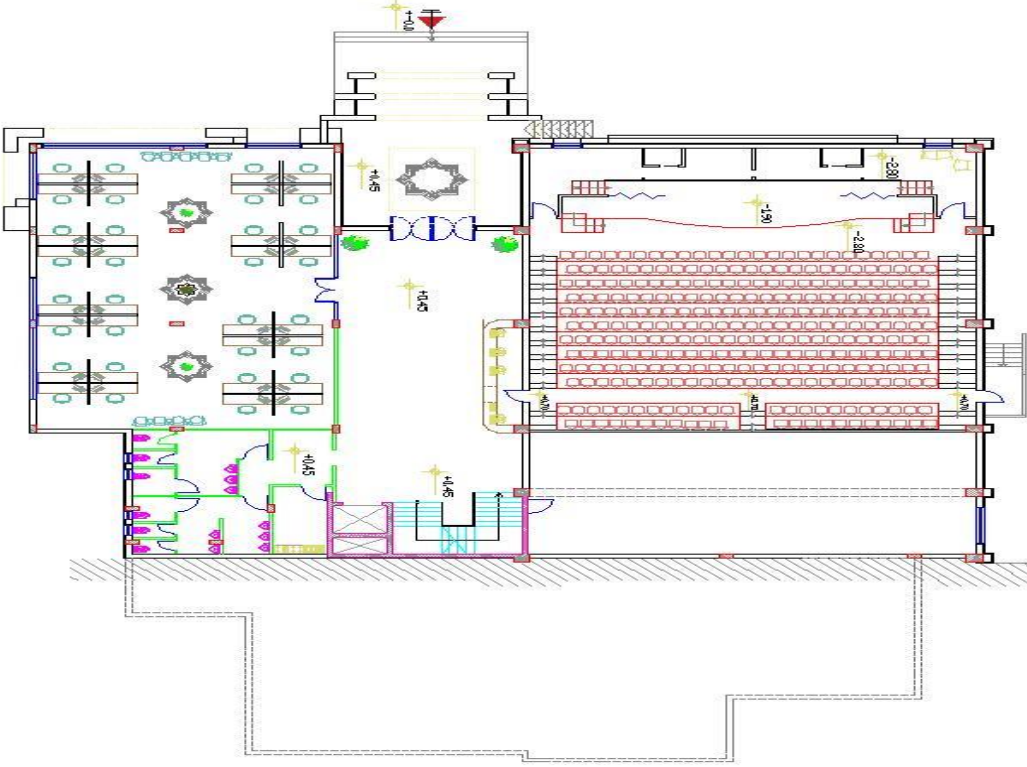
المسقط الافقي لطابق التسوية.
